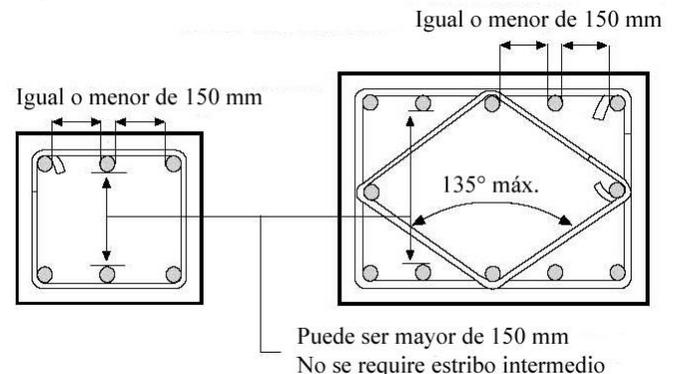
Croquis para aclarar las medidas entre barras de columna apoyadas lateralmente
